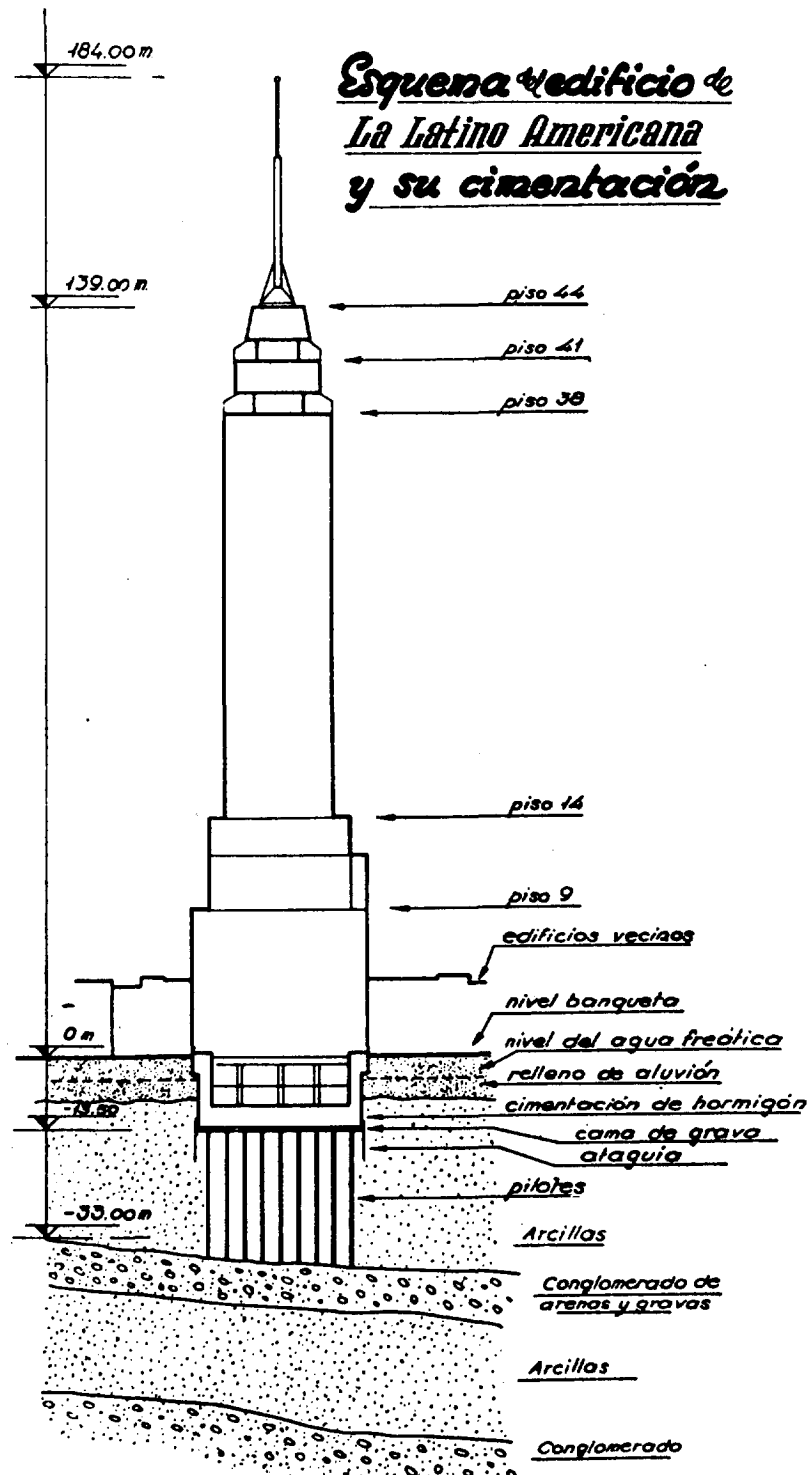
^a. -- Esquema del alzado y cimentación del edificio de la "Latino-Americana".
